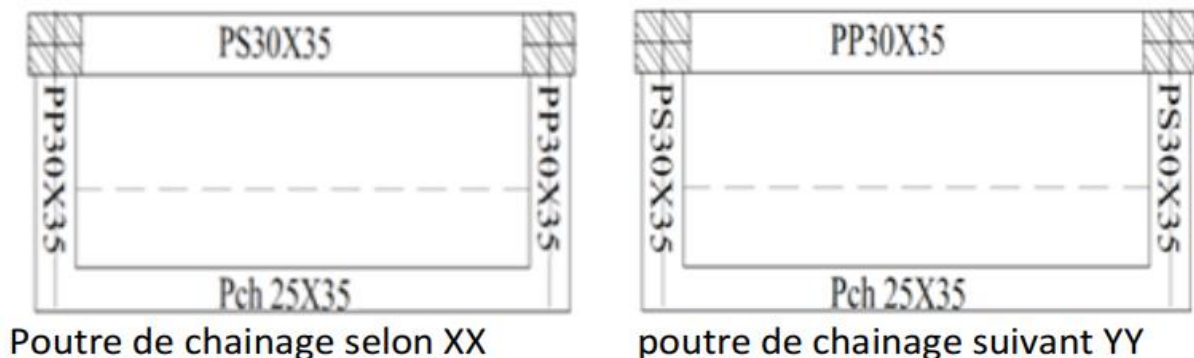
Poutre de chaînage :(suivant l'axe xx et y-y)
